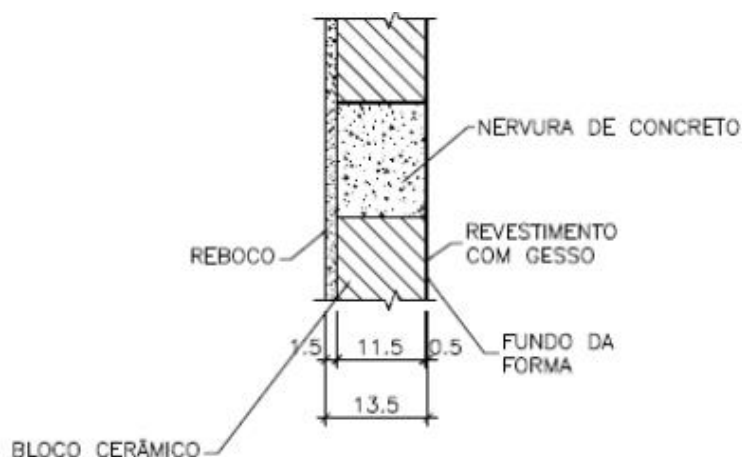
Detalhe do painel do sistema construtivo PRECON
